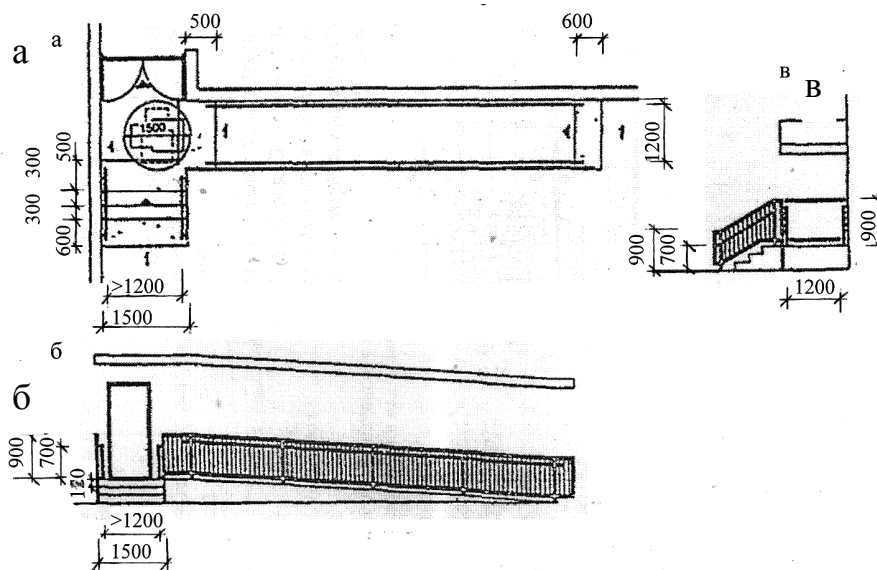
Пример наружного входа в здание с лестницей и пандусом: а – план; б – вид со стороны лестницы; в – вид со стороны пандуса
